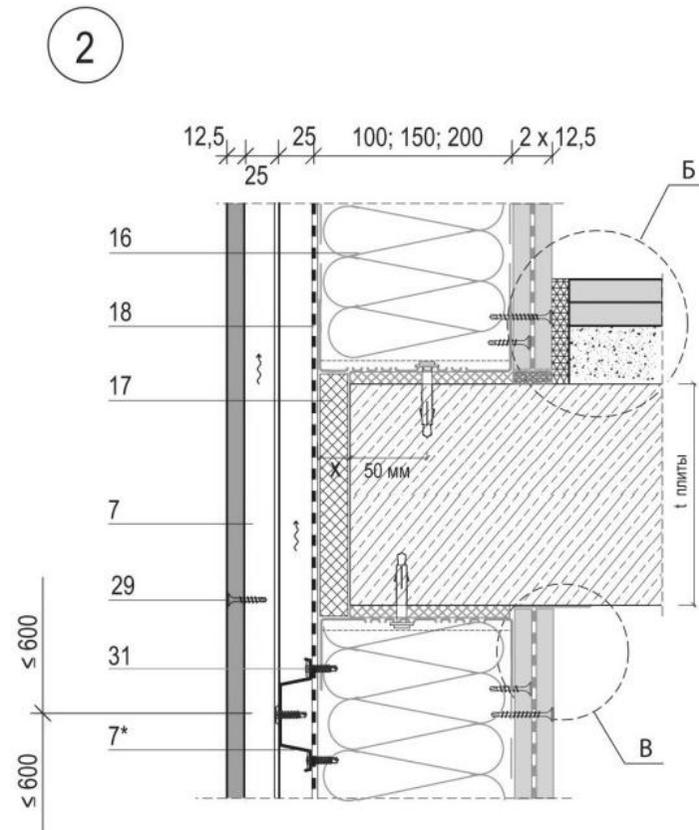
Состав наружной встраиваемой термопанели и узел опирания и примыкания к междуэтажному перекрытию:
